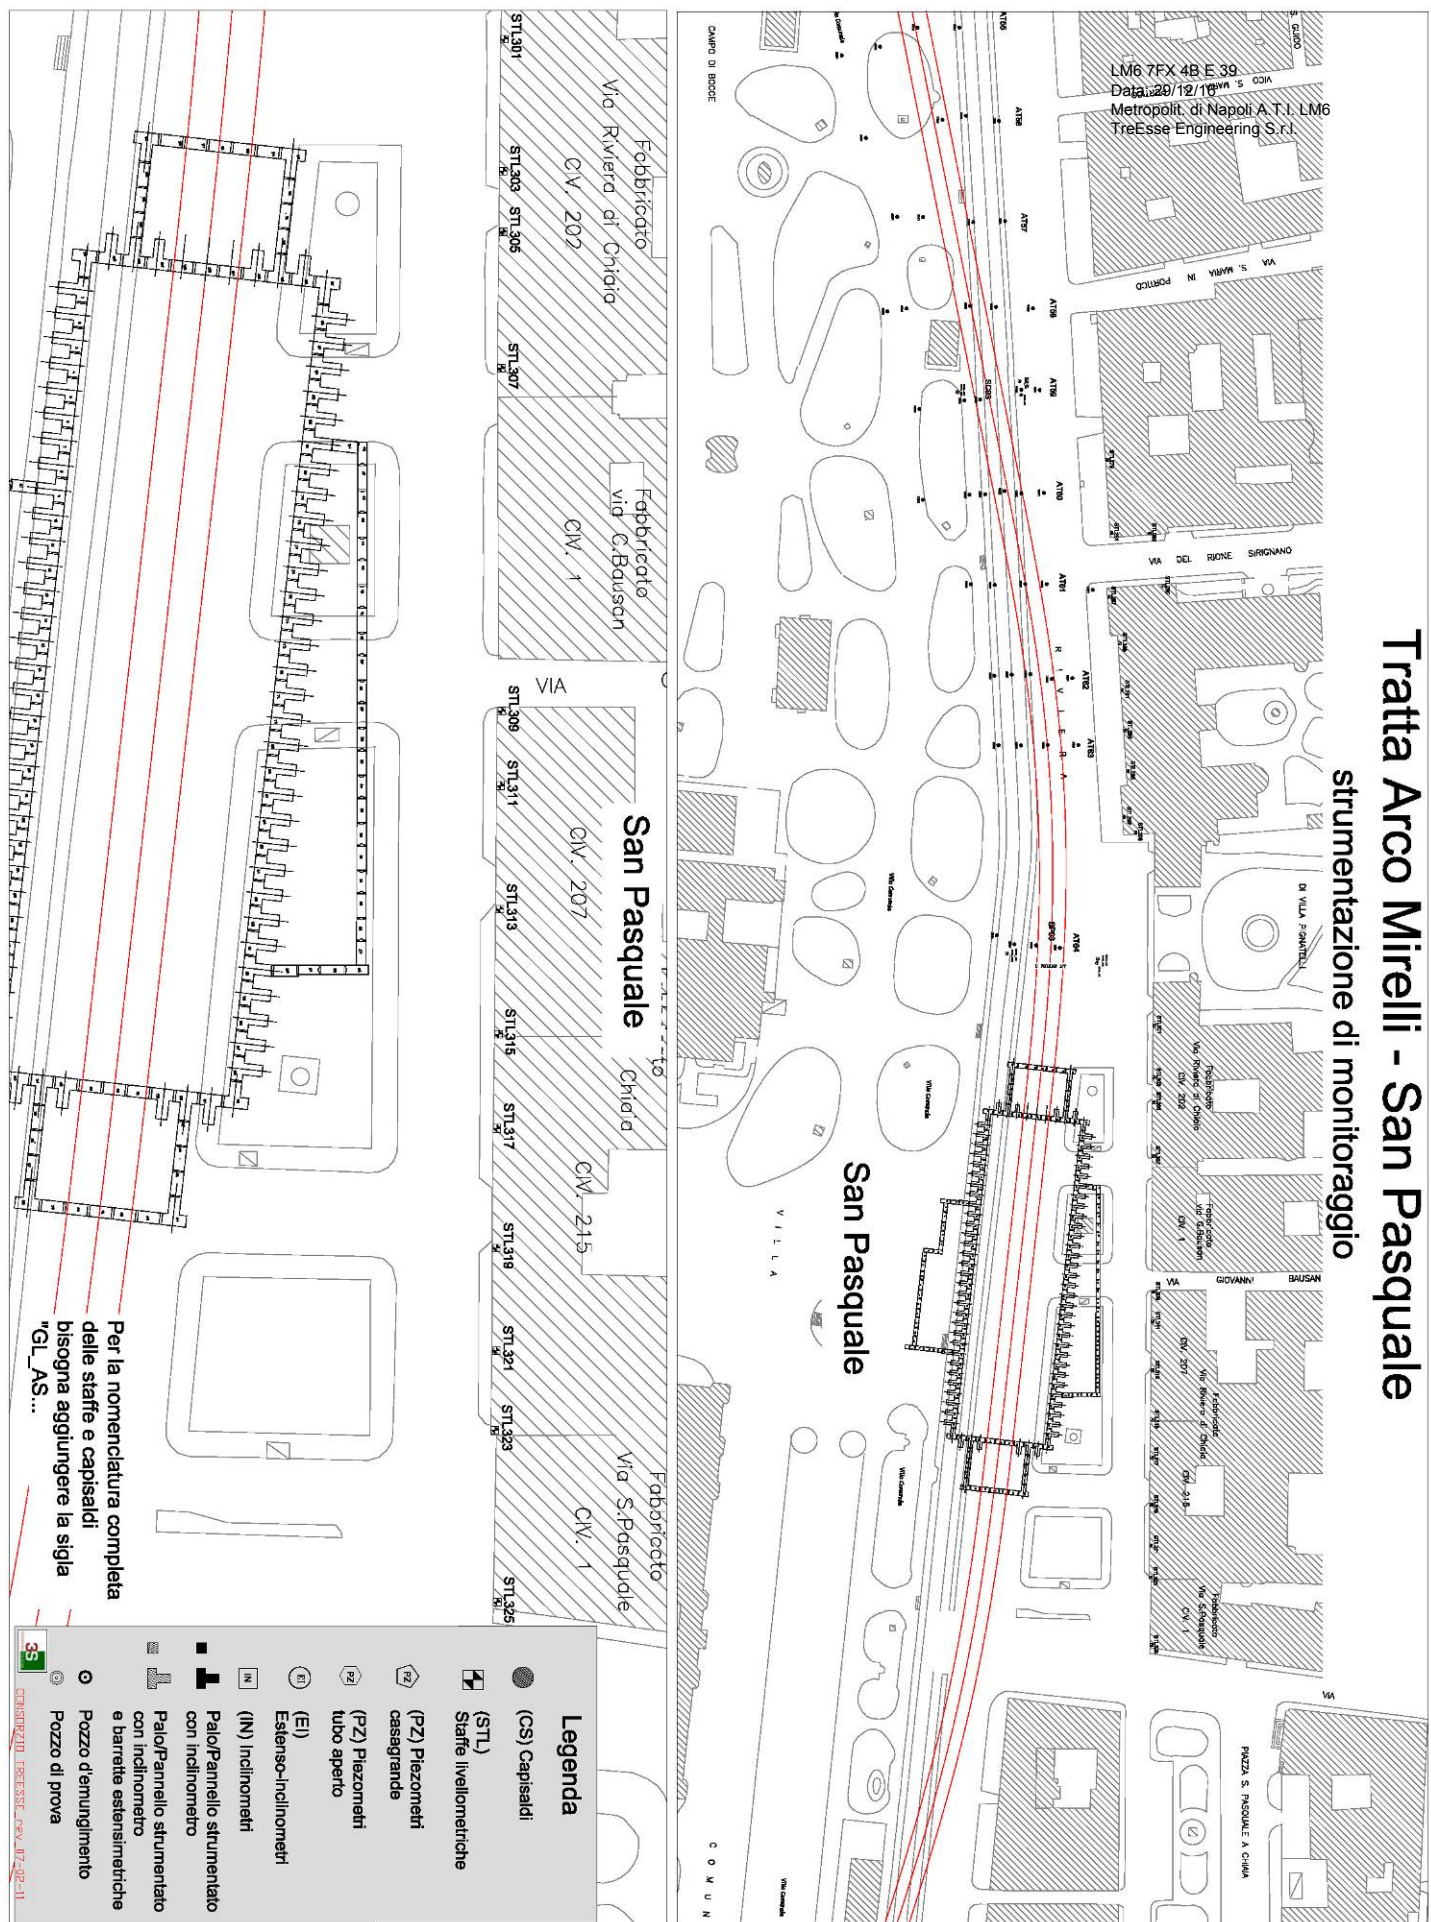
Planimetria tratta Arco Mirelli-SanPasquale, raffigurante la disposizione della terza installazione della strumentazione di monitoraggio.
